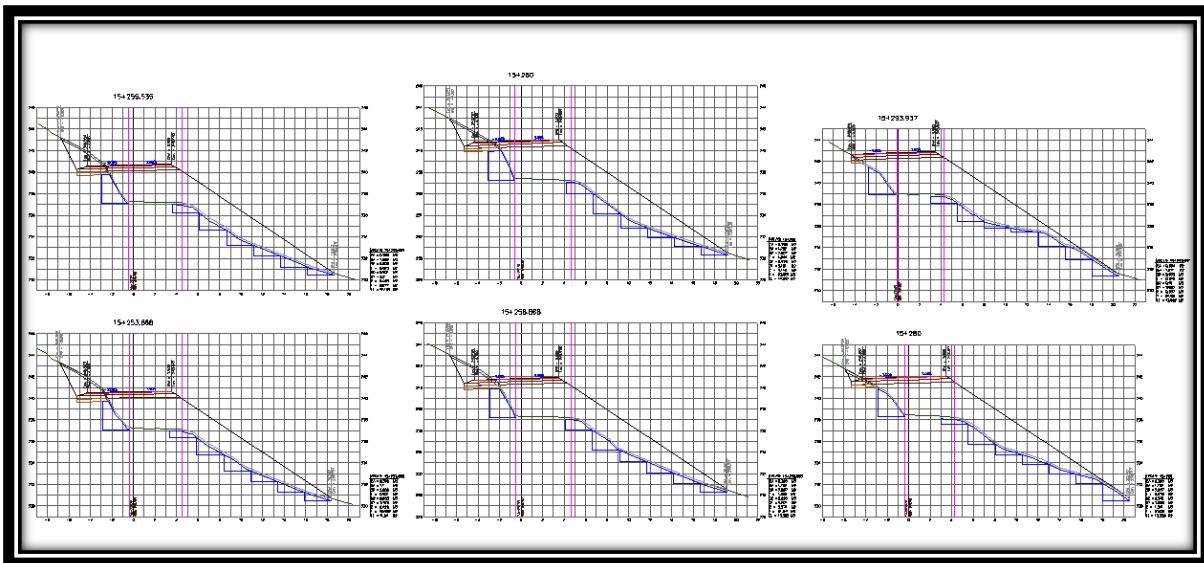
Secciones de construcción del km 15+253.868 al km 15+293.937.
